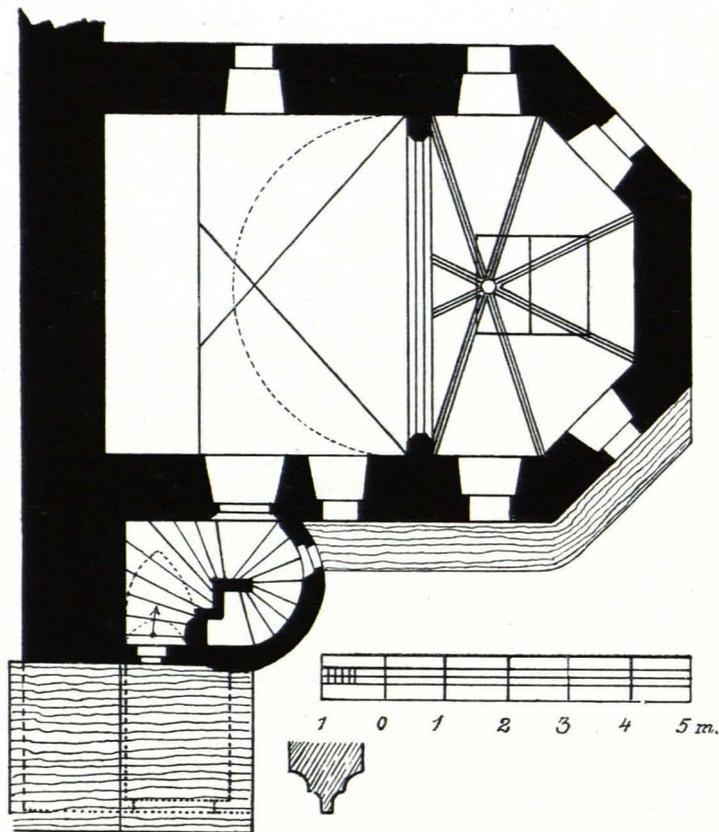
Radeck. Schloßkapelle, Grundriß 1 : 120 (S. 446)
